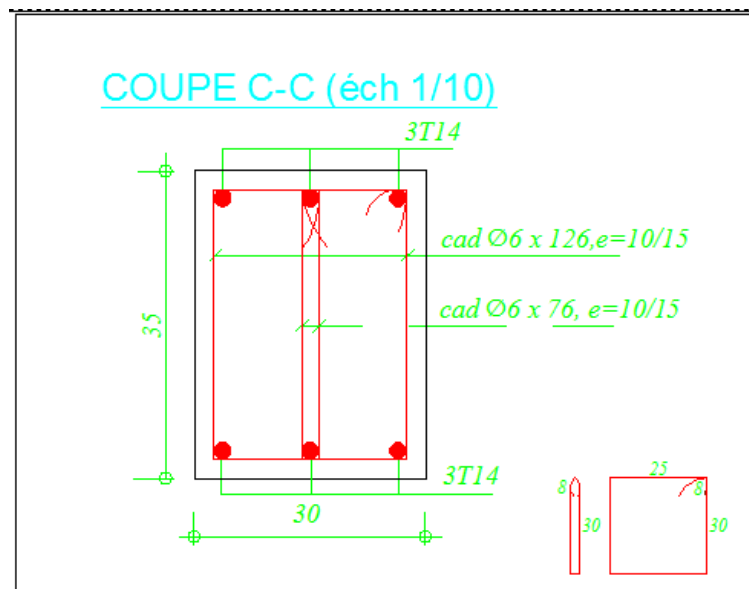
Schéma de ferrailage des poutres secondaires.
